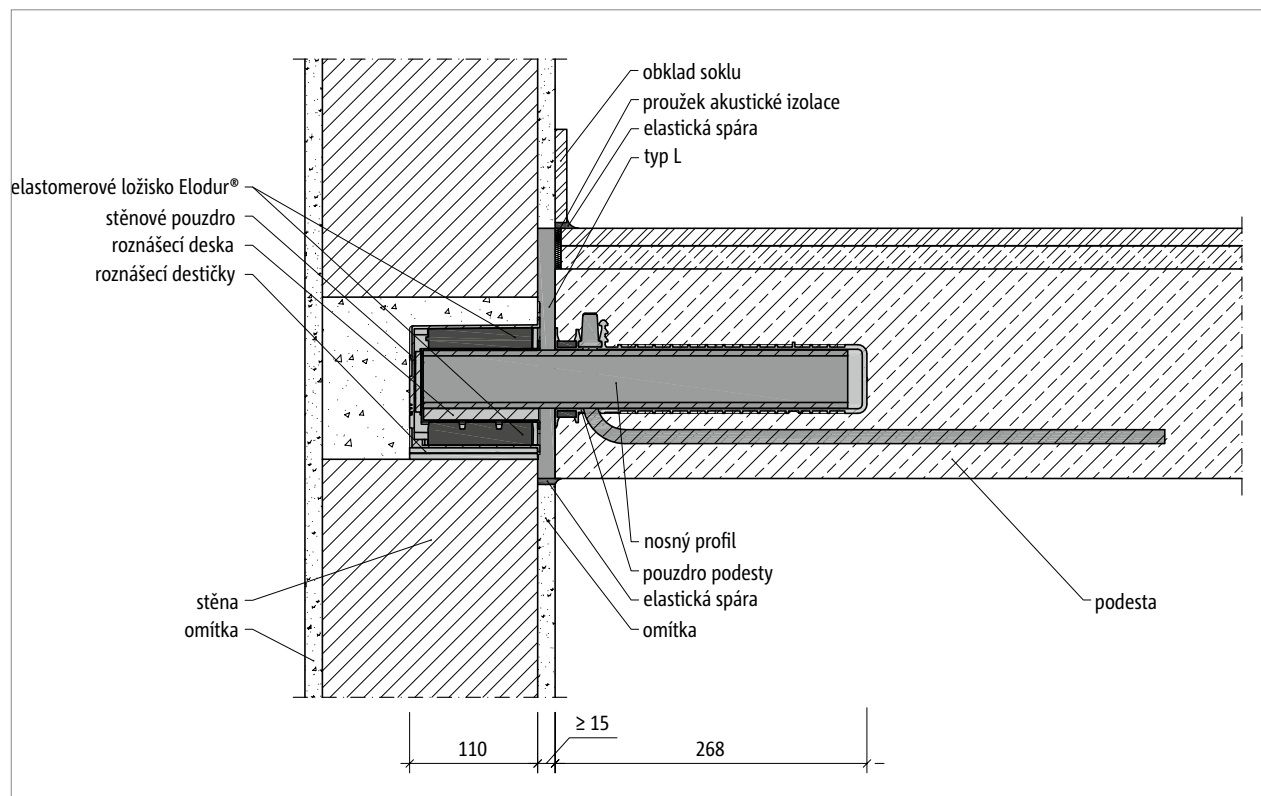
Schöck Tronsole® typ P: Řez napojením s prefabrikovanou podestou a prvkem Tronsole® typ L
